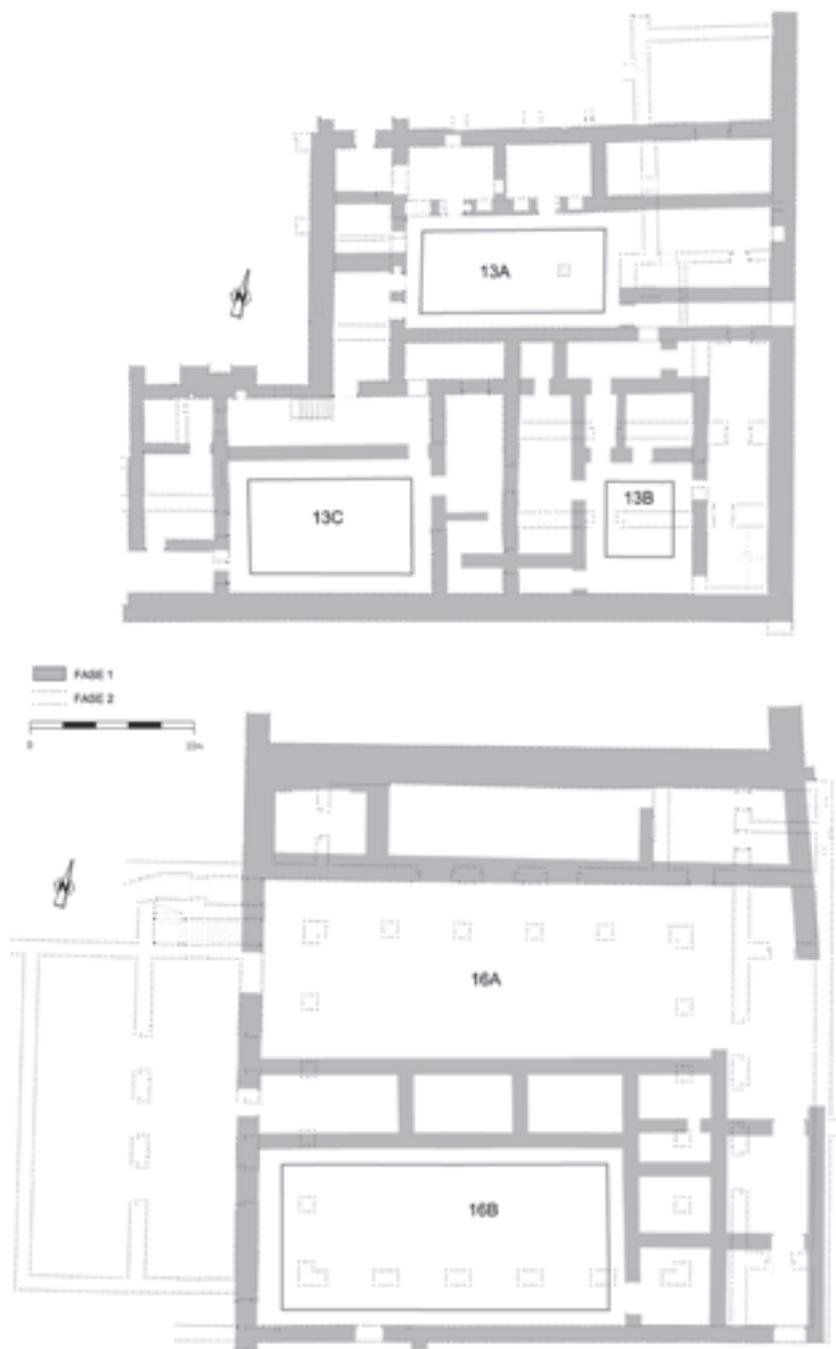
Casa de Ya'far y Patio de los Pilares con las viviendas preexistentes
